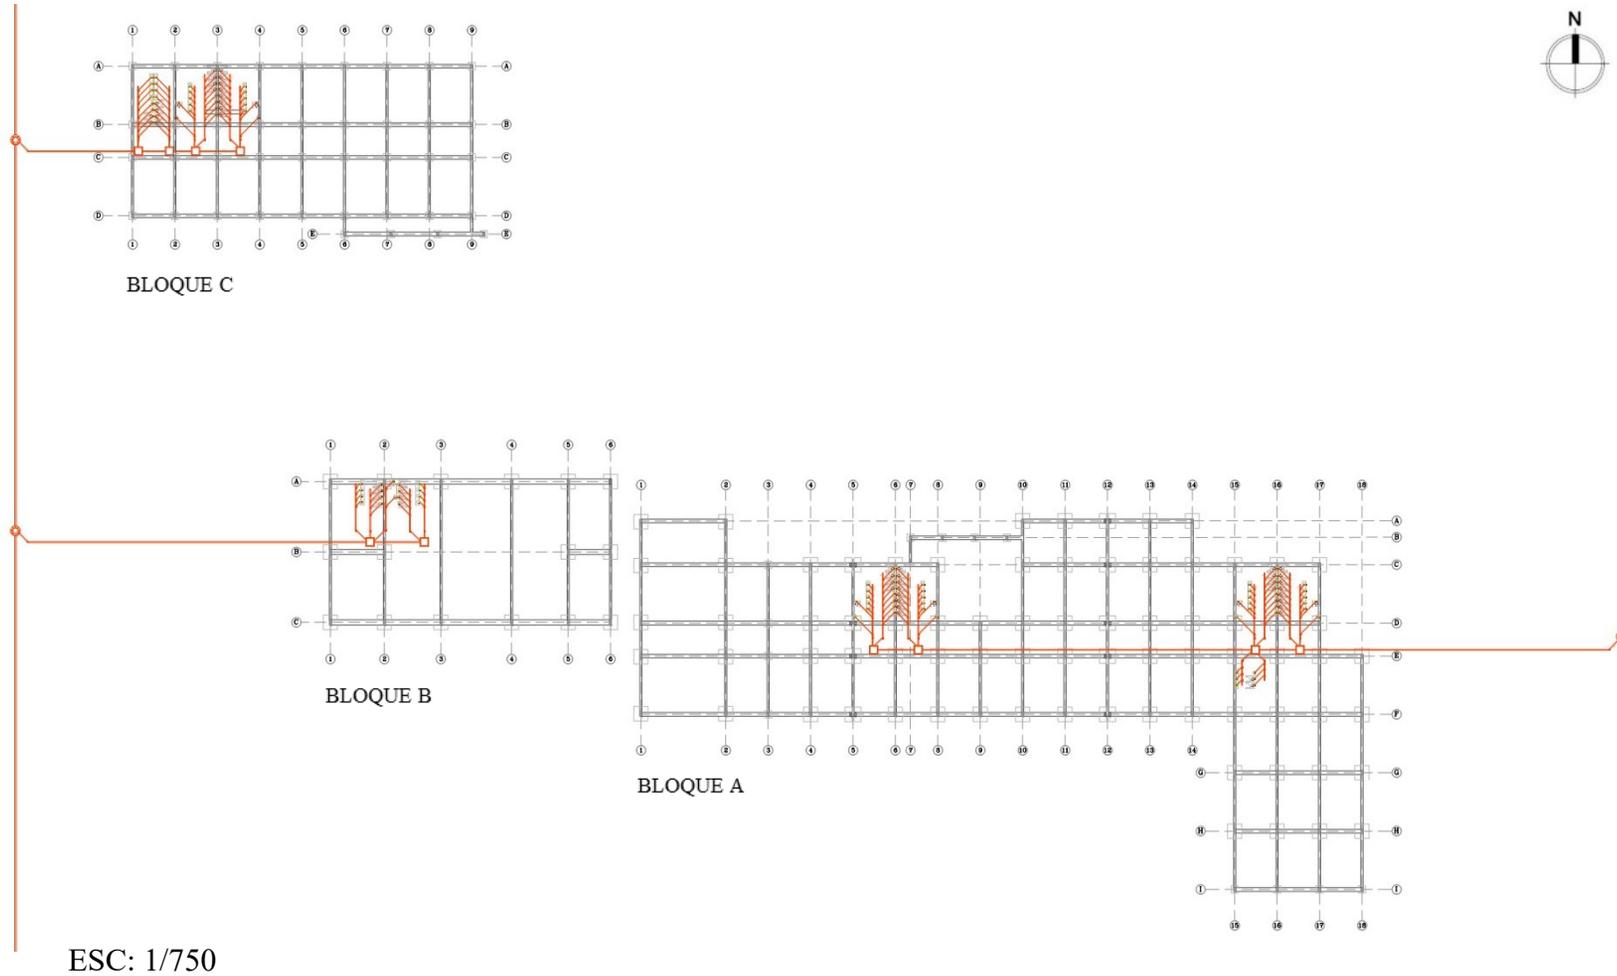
Plano de Desagües / Fuente: Elaboración propia
